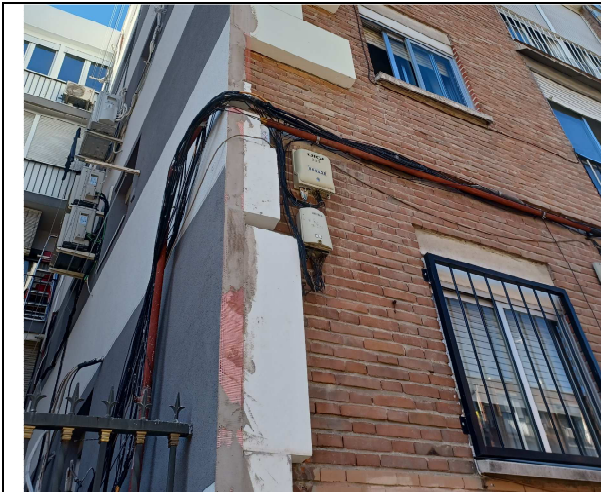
Edificio con sistema de aislamiento externo de poliestireno expandido
